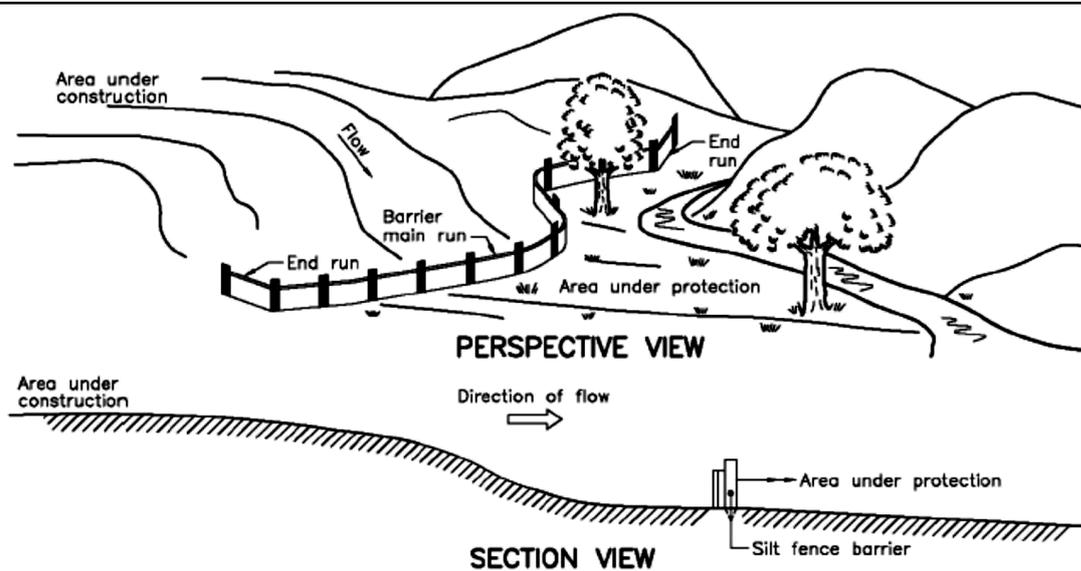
Técnicas de Control de Sedimentos en Areas de Construccion
